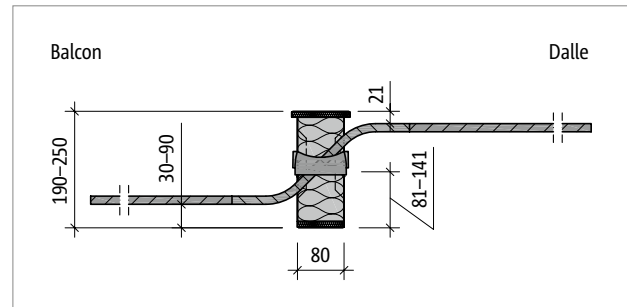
Schöck Isokorb® T type Q-E-V7 : coupe du produit
